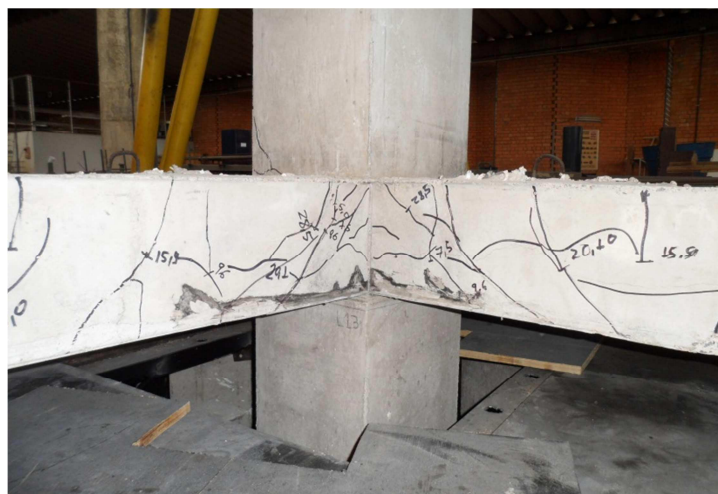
Aspecto das fissuras na reentrância da laje LC02
